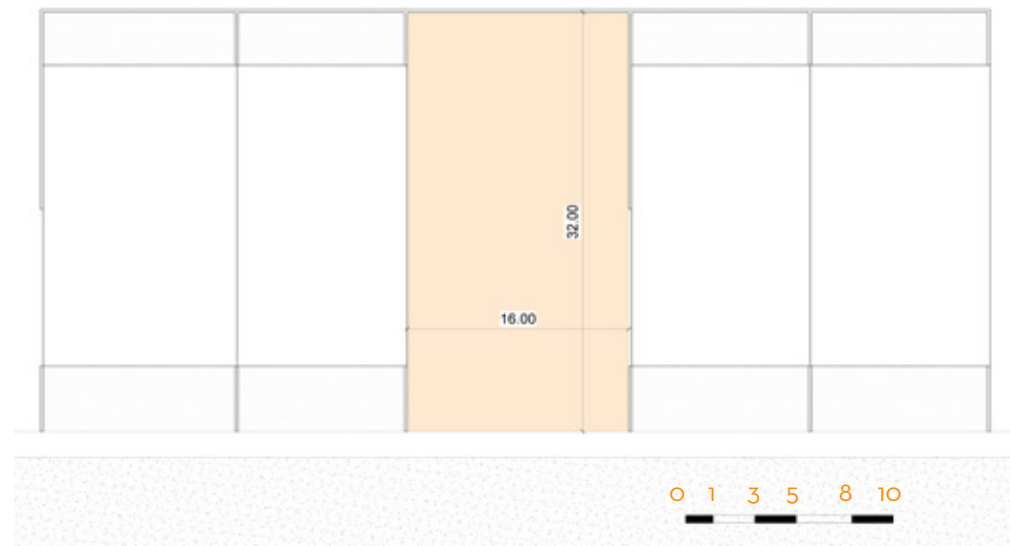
Planta Lote Tipo. Fuente: Autores, 2023
